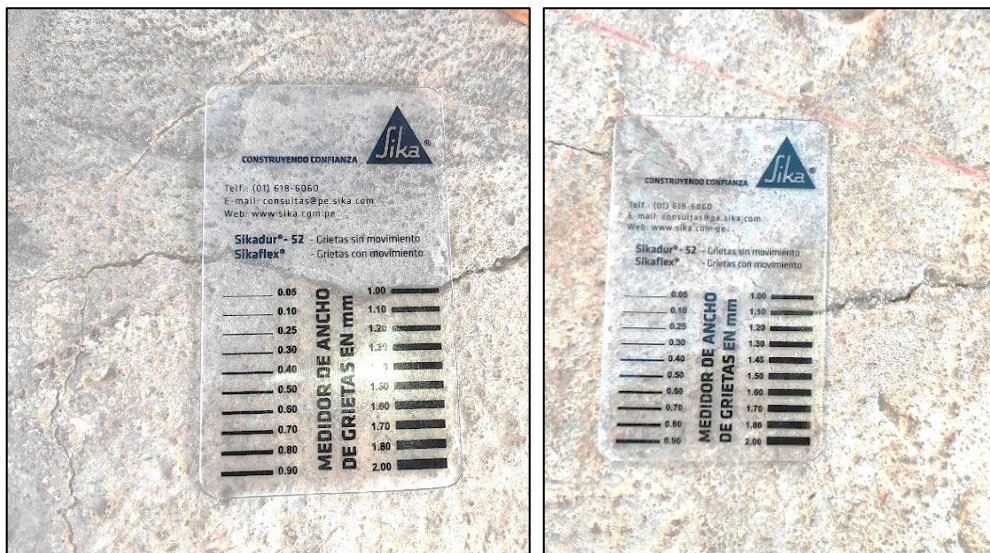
GC1 y GC2 control de dimensiones de fisuras a las 72 horas de terminado el proceso de vaciado.
